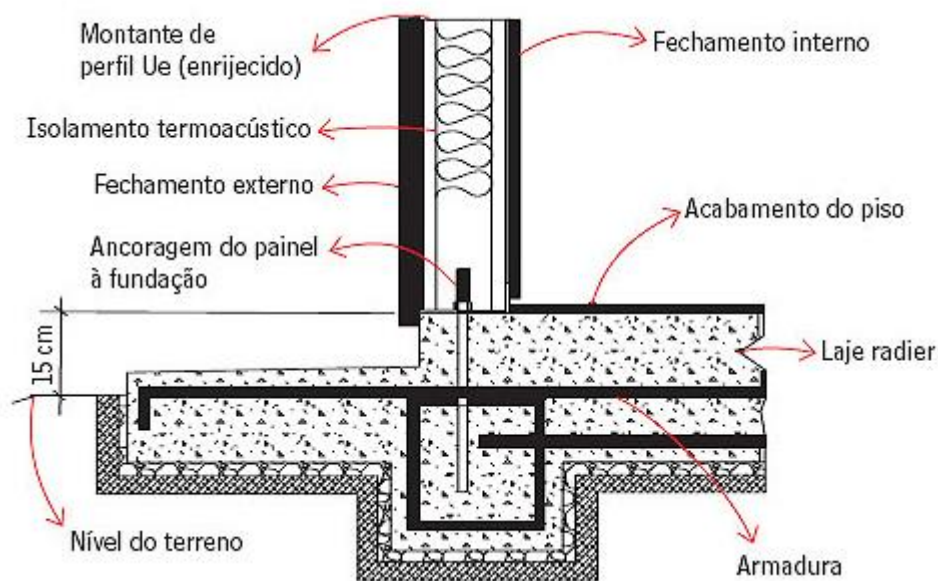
Detalhe Esquemático de ancoragem de painel estrutural a uma laje radier (Fonte: TÉCHNE, 2008)
